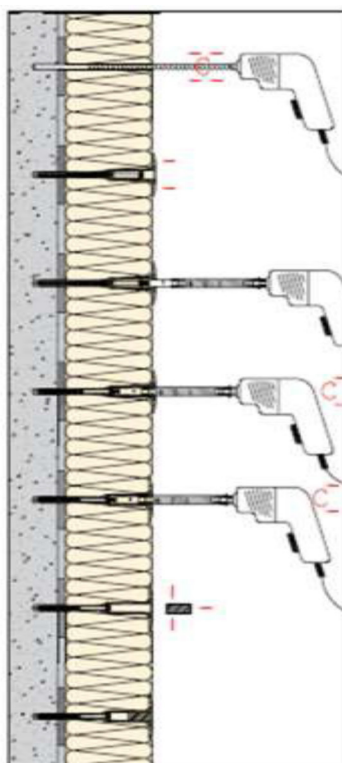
Colocación aislamiento con anclaje Ejothem STR U 2G
